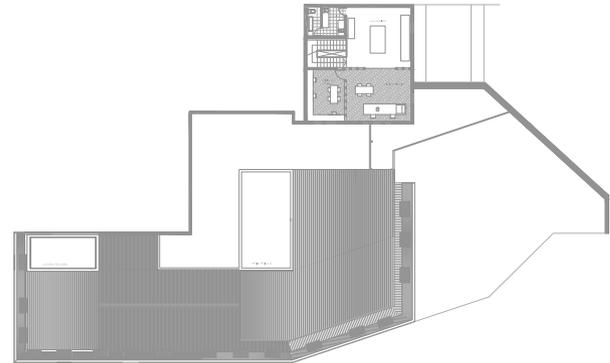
Planta 5to nivel, Centro Extensión GAL_212
